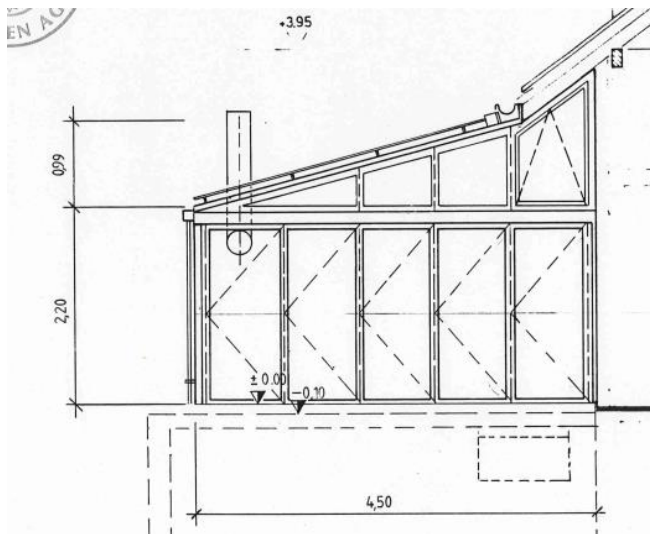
Plan Südost-Fassade, vom Gemeinderat gemäss Baubewilligung vom 10. Oktober 1988 bewilligt
